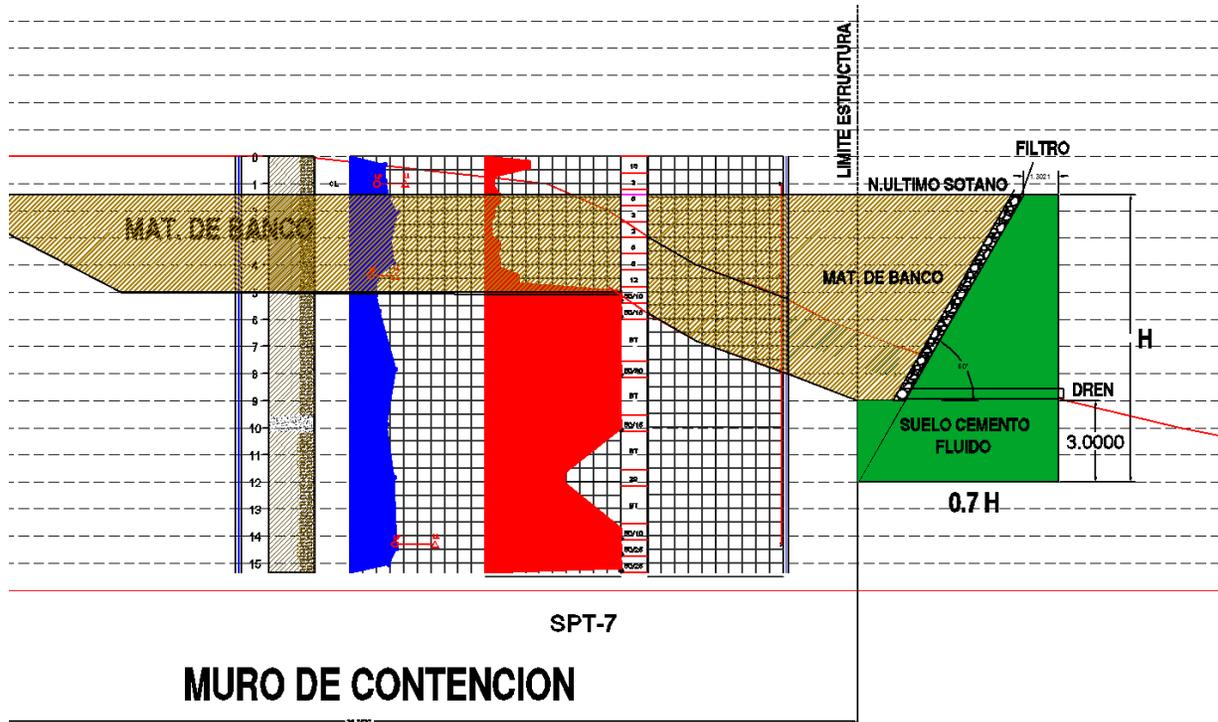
DETALLE DEL MURO CONTENCIÓN
